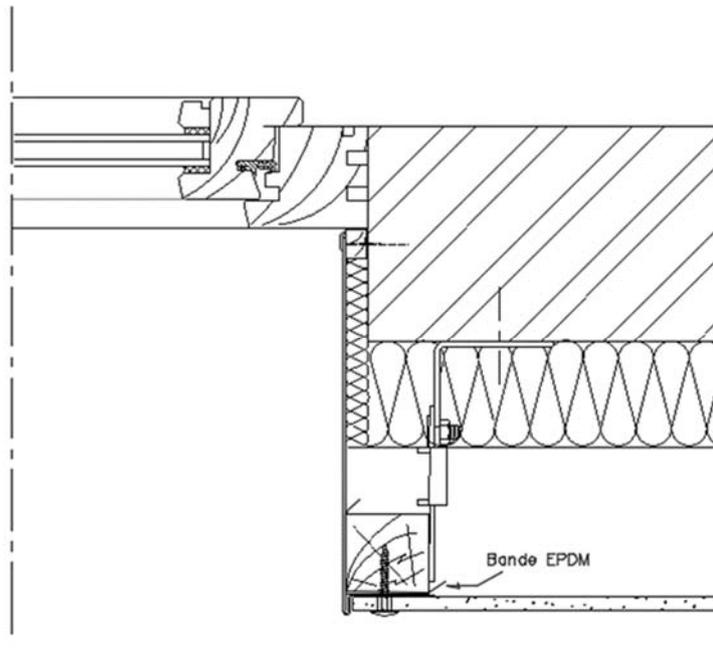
Encadrement de fenêtre (coupe sur tableau)
